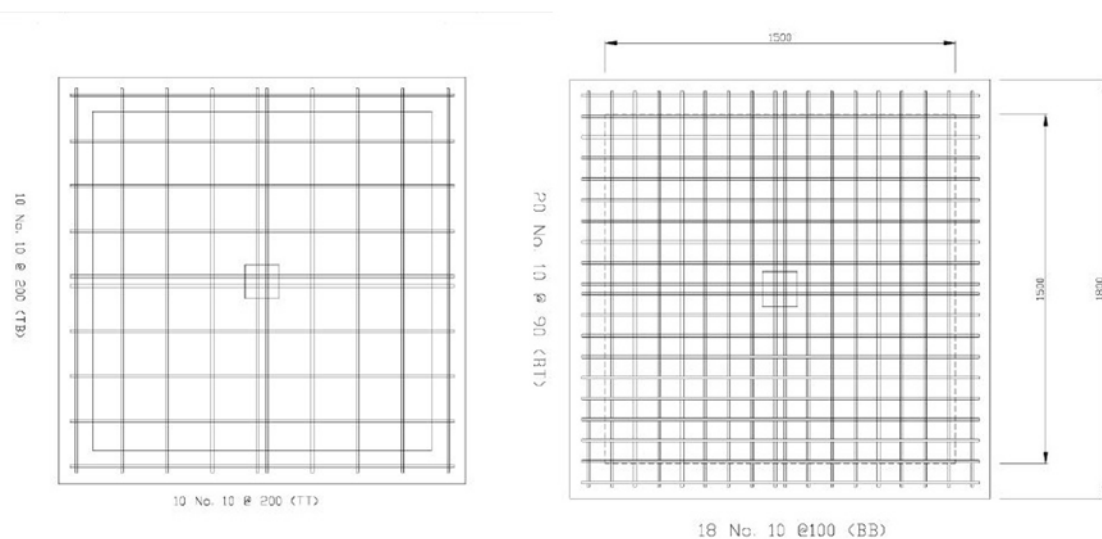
Geometria e distribuição da armadura longitudinal
